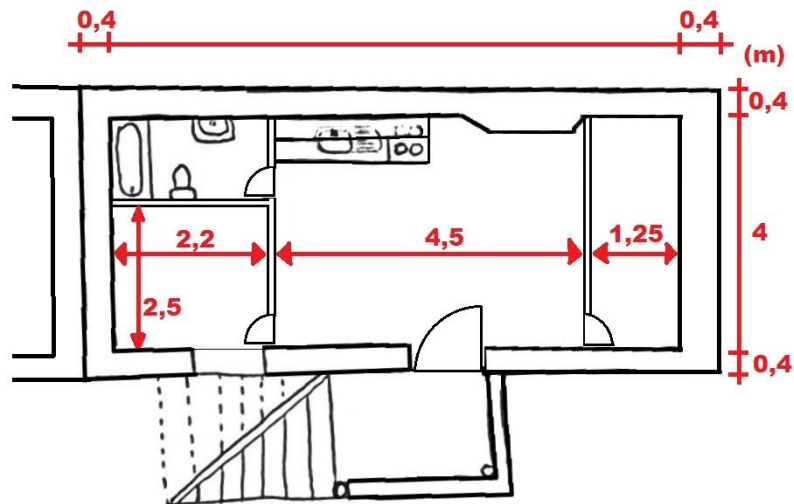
Fogo exemplo em alvenaria de pedra, planta
